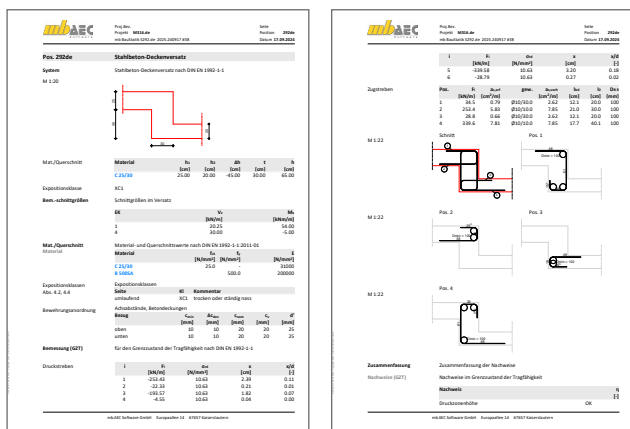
Bemessung in Querrichtung mit BauStatik-Modul S292.de
